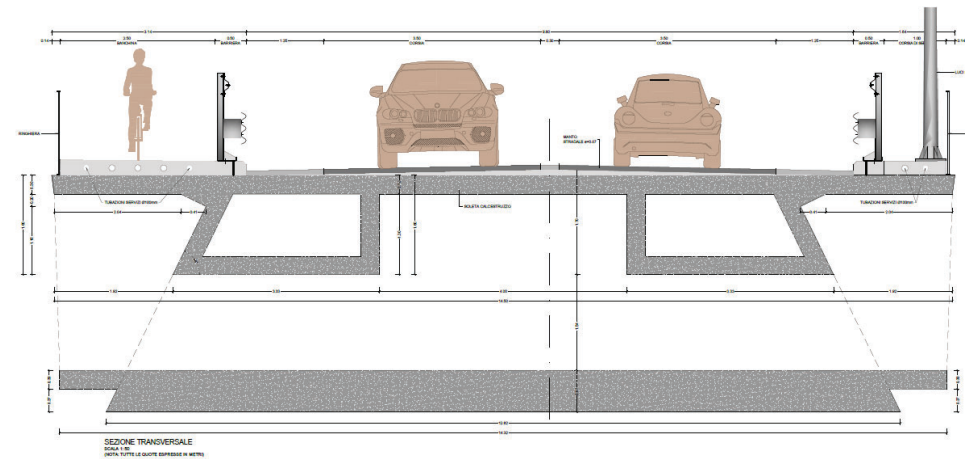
Sezione trasversale del nuovo ponte nei pressi della pila
